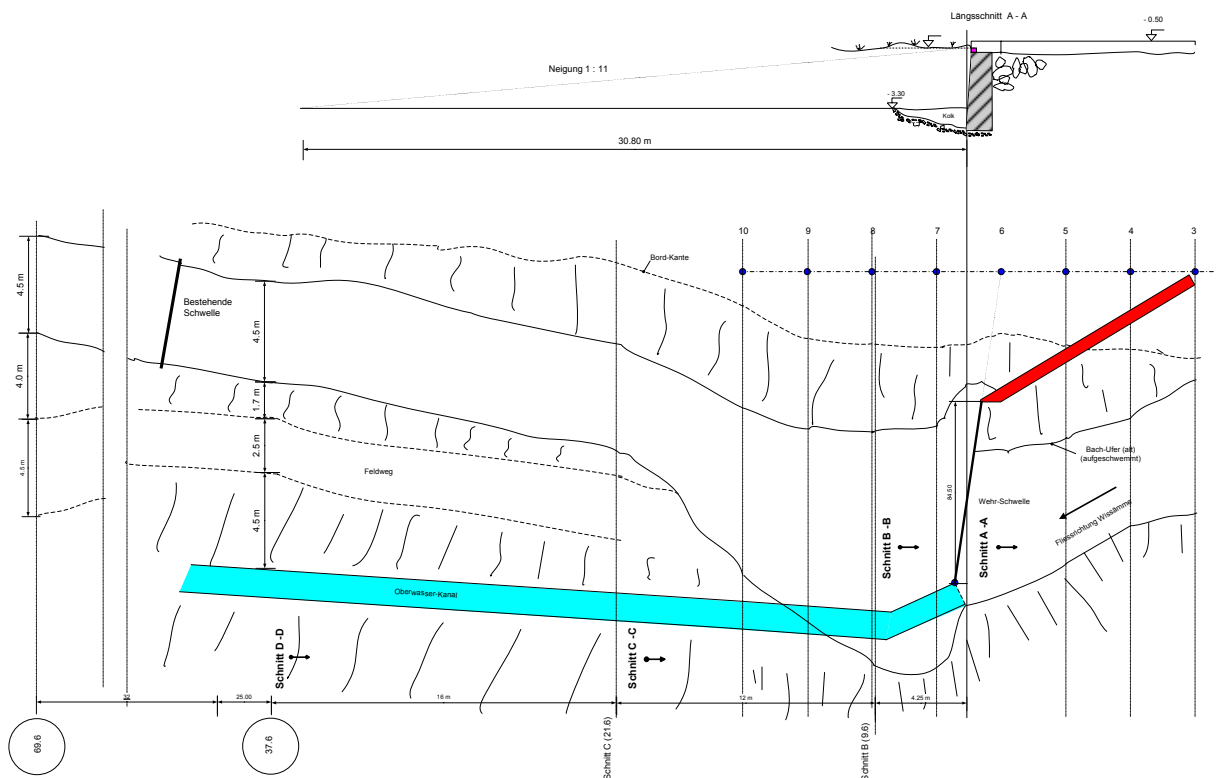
Grundriss „Ist“ der Ausleitung
